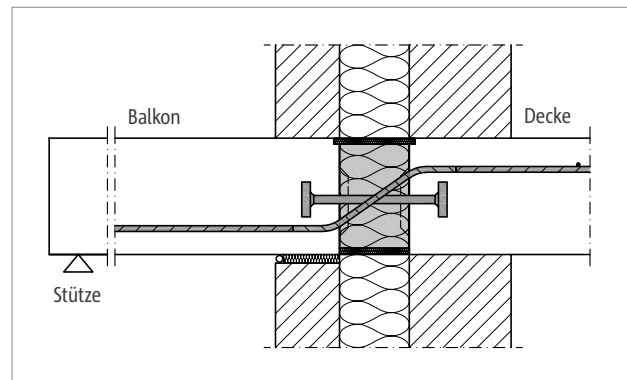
Schöck Isokorb® XT Typ QP: Anschluss gestützter Balkon bei zweischaligem Mauerwerk mit Kerndämmung
